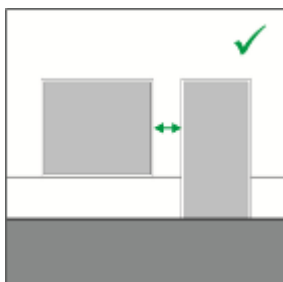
Schaufensterunterkante bis zum Gebäudeabschluss
